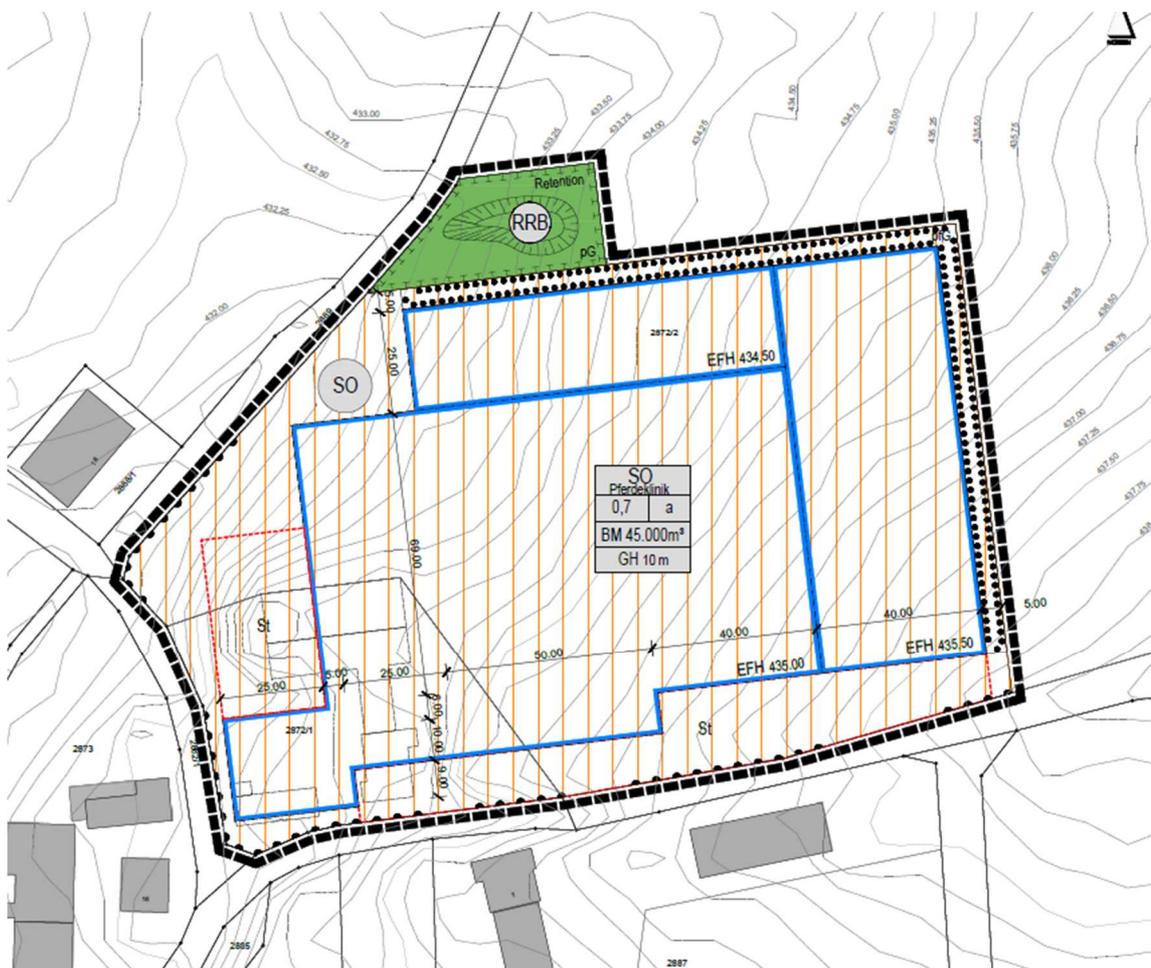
Bebauungsplan (Stadt Crailsheim)
